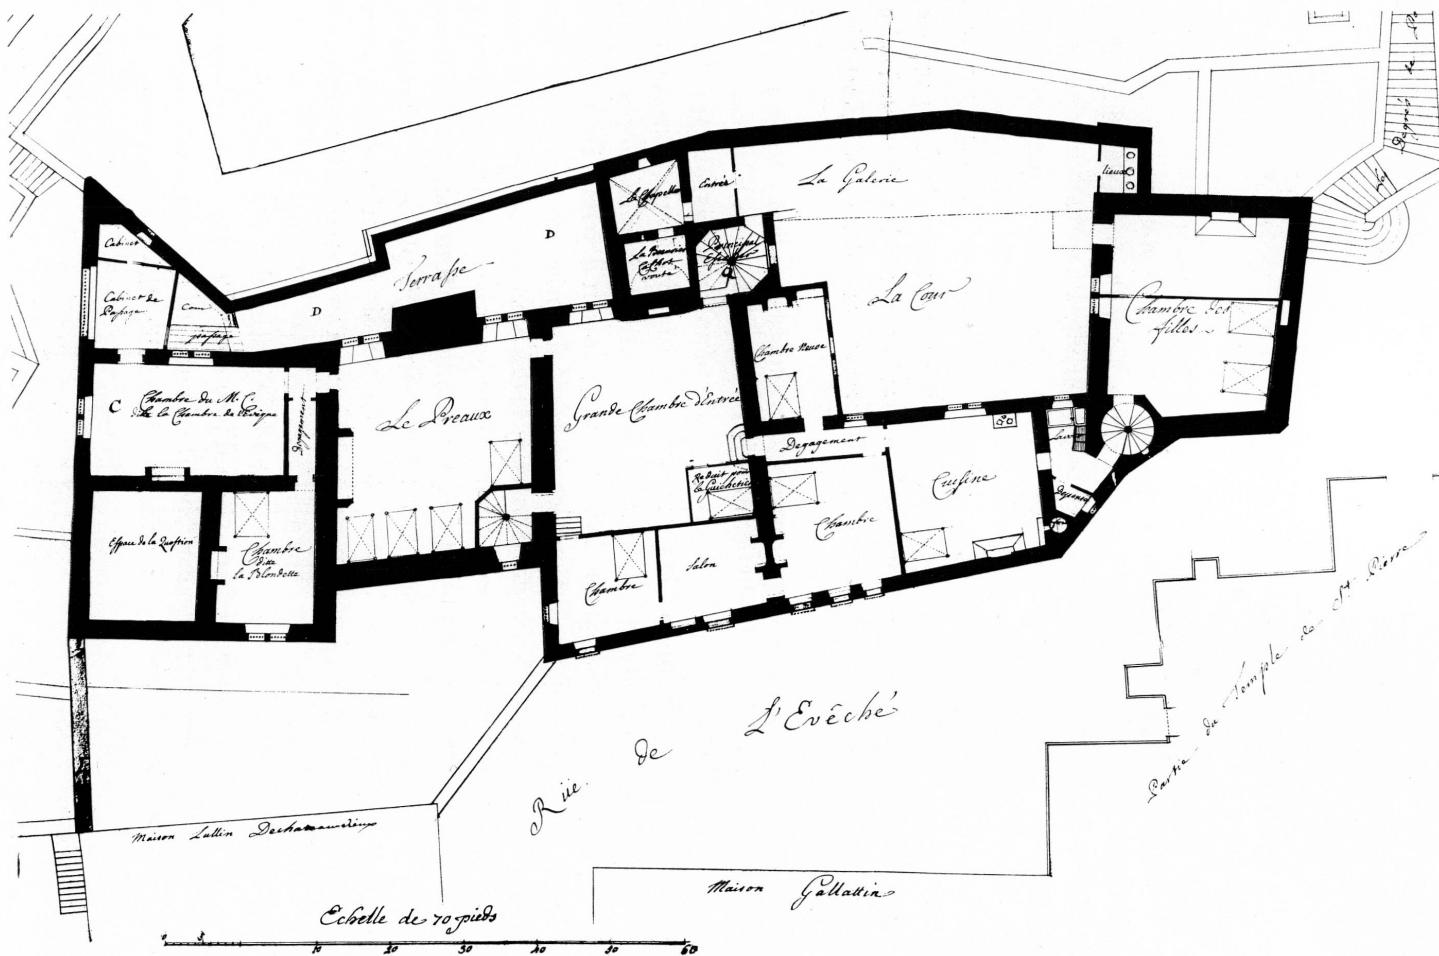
Plan Billon de 1764. « Plan du premier et grand étage des prisons. »
